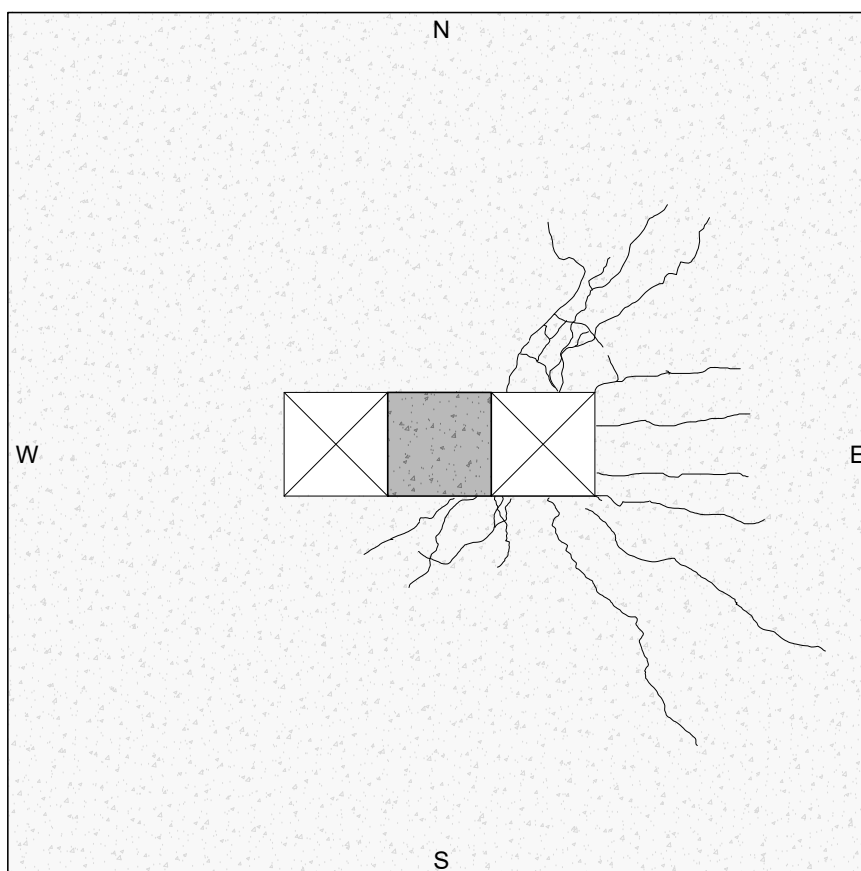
Padrão de fissuração da laje LFE2
